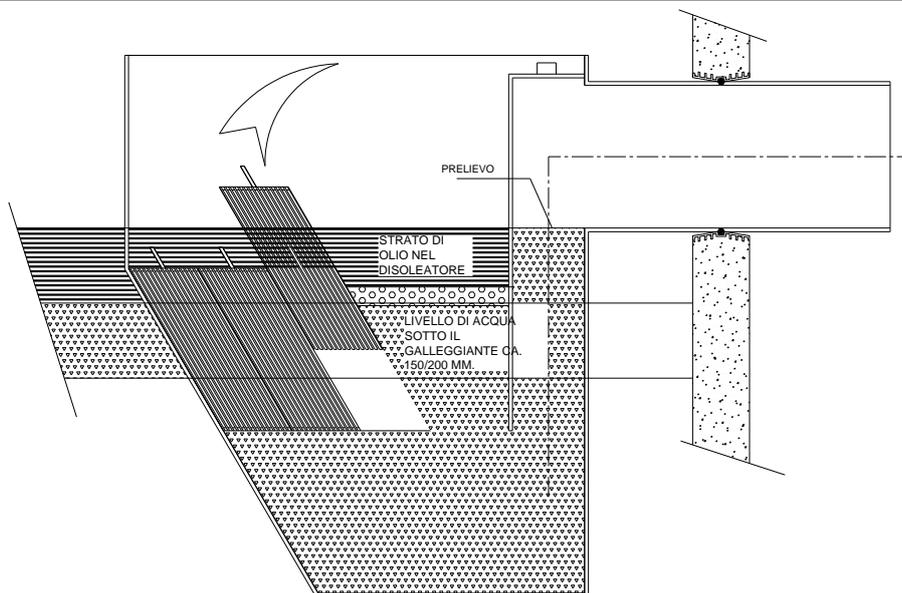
Smontaggio del pacchetto di piastre ondulate
